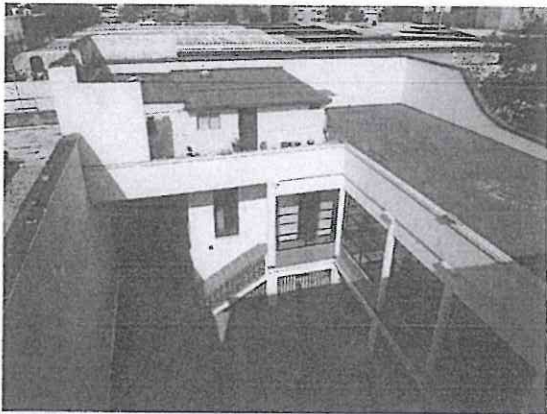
Fachada interior del primer cuerpo en "L" de un nivel, sin afectaciones estructurales.
